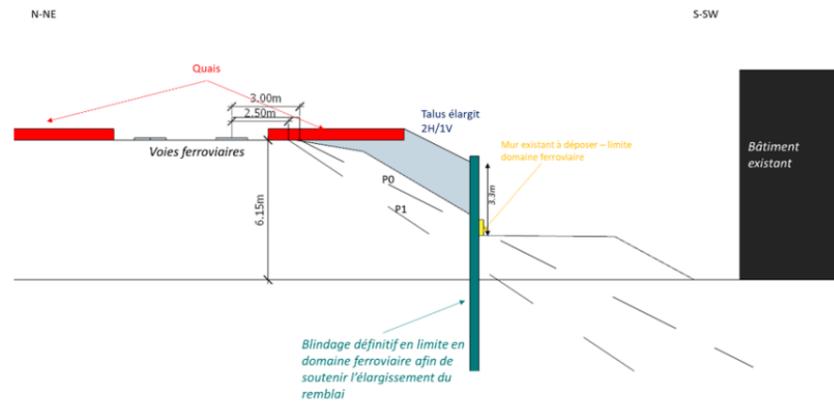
Coupe schématique 2 - halte de Saint-André (source : Systra, 2021)
